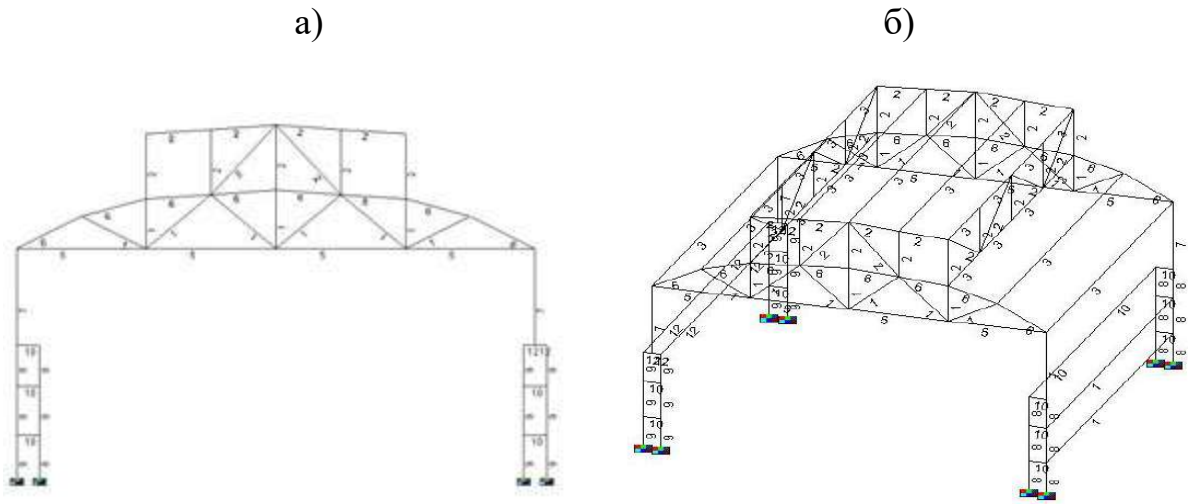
Розрахункова схема рами: а – плоска регулярна схема; б – 3D модель розрахункової схеми
